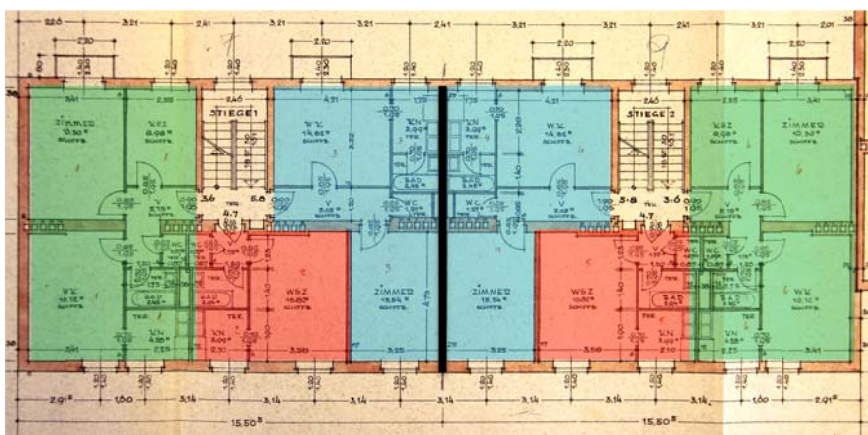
Grundriss eines Wohnhauses von 1956<sup>141</sup>
